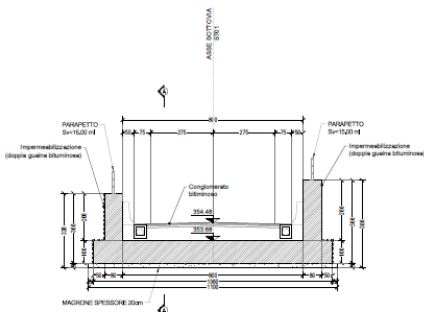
"Sezione trasversale muri di imbrocchi"
